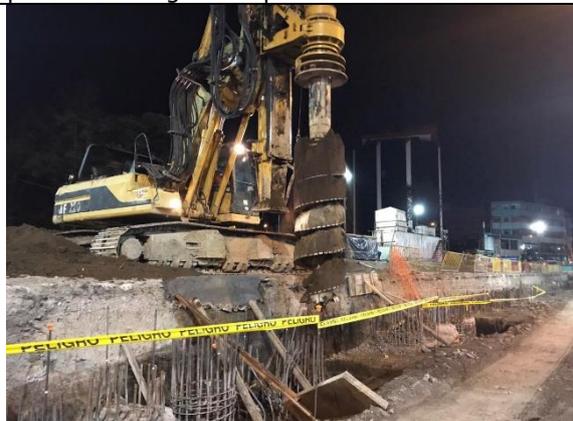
02/08/2017. Descabezado de pilotes en Av. Gran Colombia
